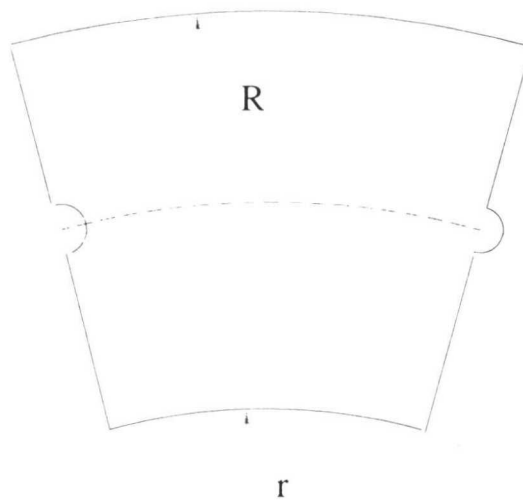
Vista en planta de un bloque de los fabricados para el ensayo en maqueta
